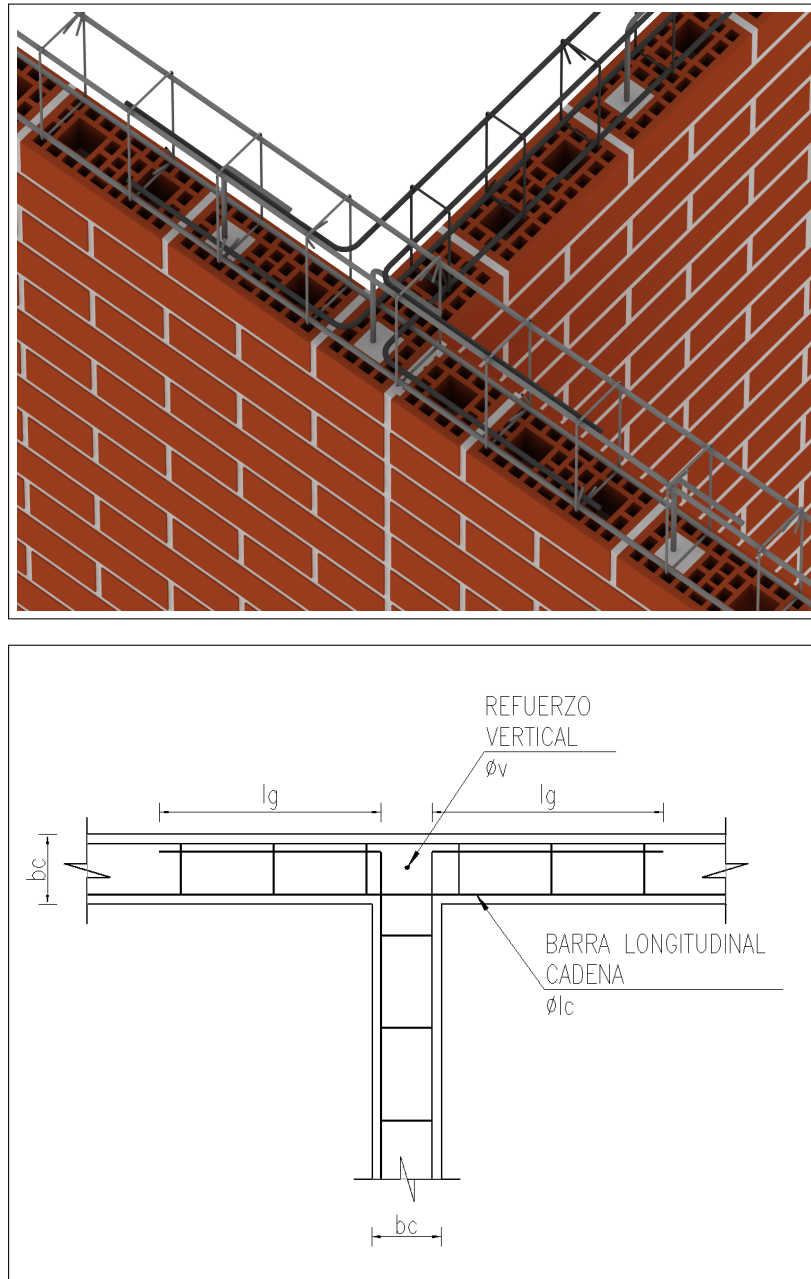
Detalle de las barras longitudinales de las cadenas de confinamiento en un encuentro en T.
